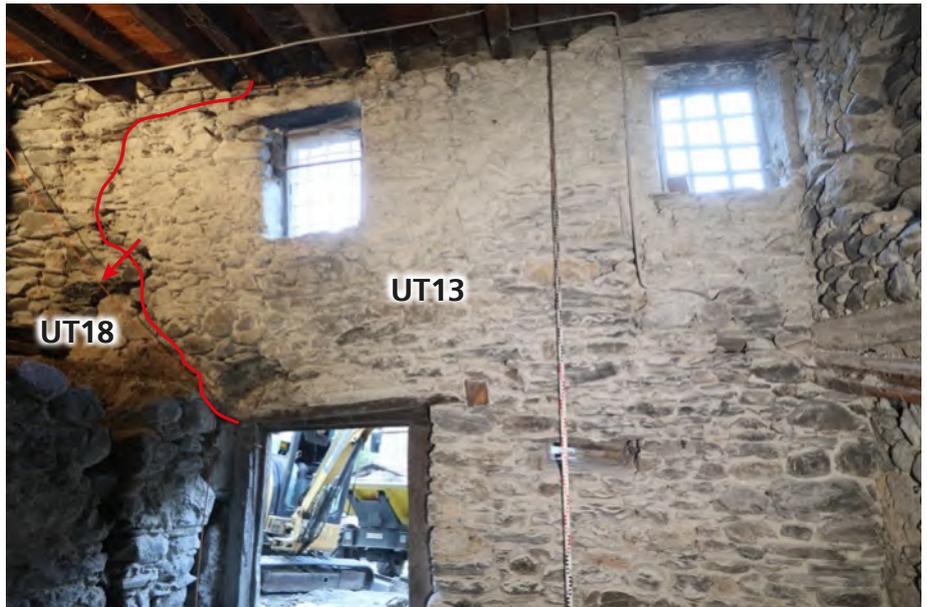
Dans le bâtiment 1, le doublage (UT19) de la paroi nord (UT20) est appuyé contre le piédroit de la fenêtre ouest. Le parement de la paroi ouest (UT18) a été remplacé par une maçonnerie (UT13) de faible épaisseur. Vue de l'est.
